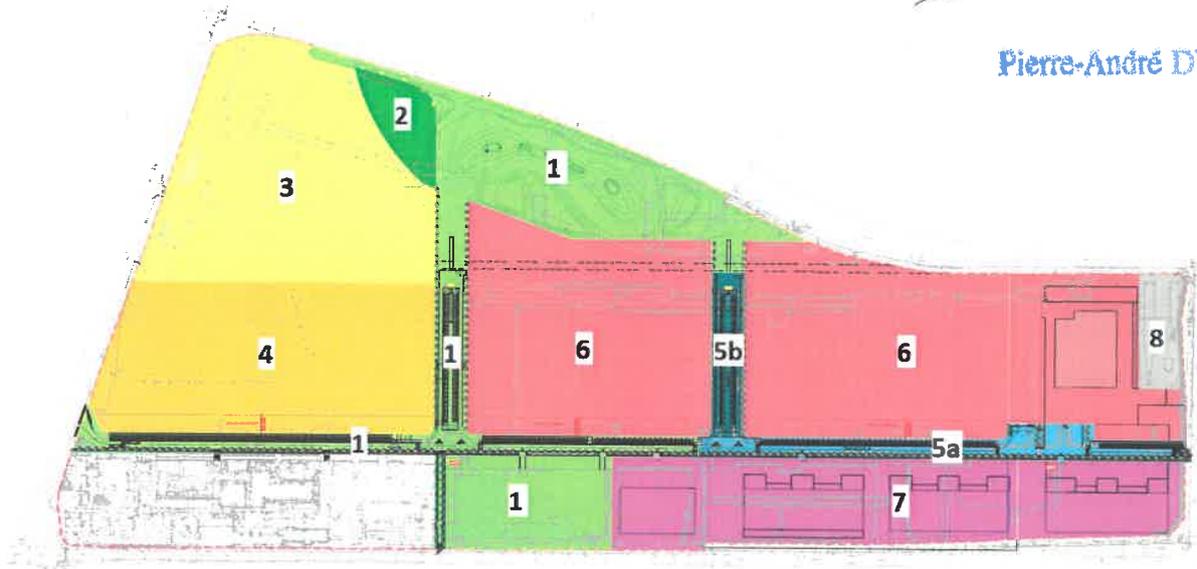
Plan d'aménagement avec les différentes tranches de réception
